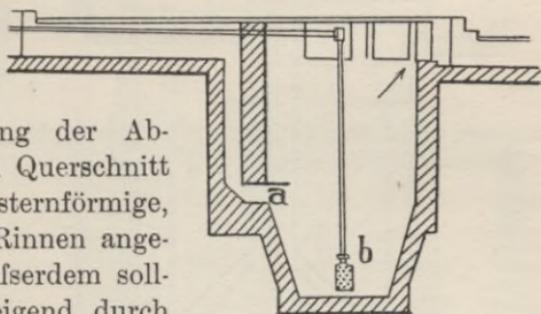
Klärbrunnen in Halle, Müller-Nahnsen.
